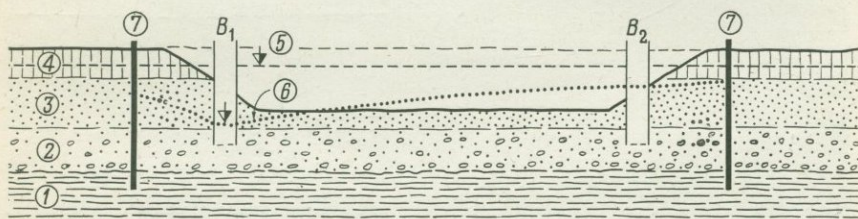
Неудовлетворительное дренирование строительного котлована.
